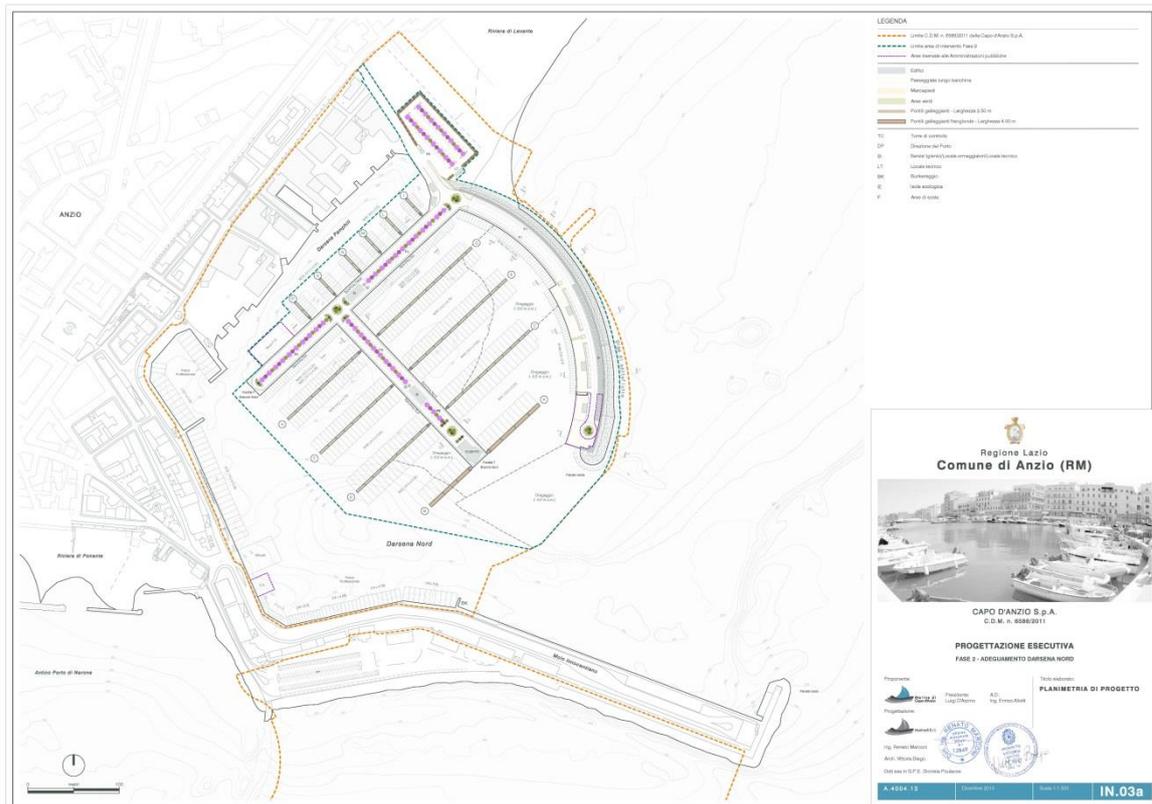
Elab. grafico IN.03a – Planimetria di progetto
